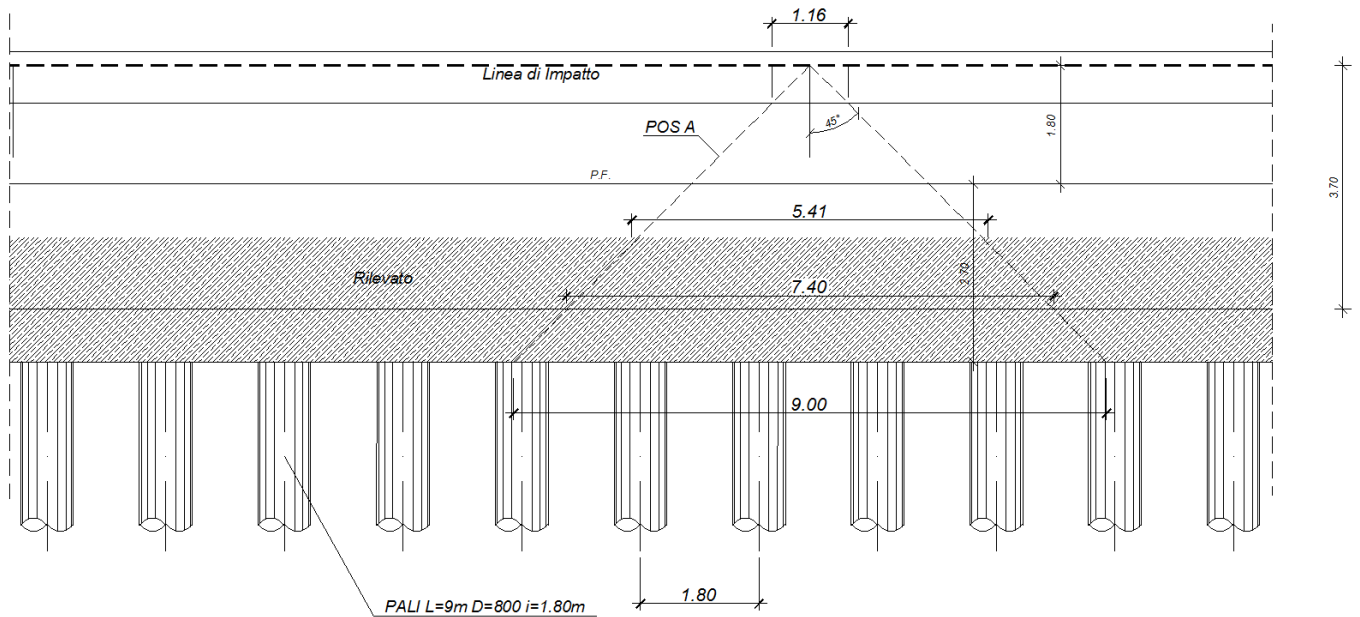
Schema diffusione azione eccezionale da urto sul paramento del muro
